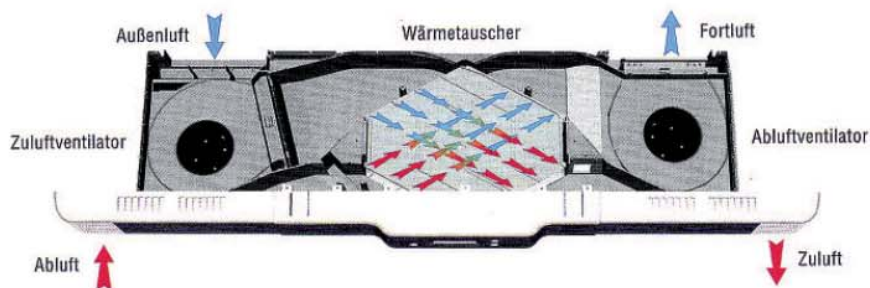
Schema der dezentralen Lüftungsanlage mit Wärmetauscher [15]
